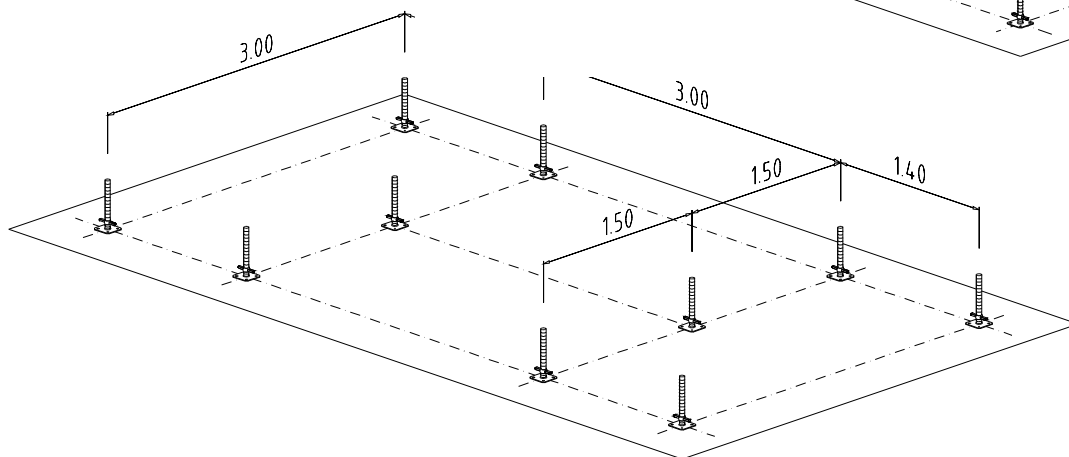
Grundriss für einen Treppenturm mit einer Laufbreite von 1,25 m
